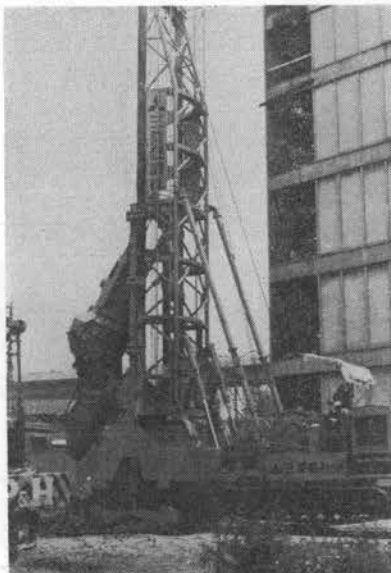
三菱大口径掘削機 MT-1 (2mφ) 施工状況
